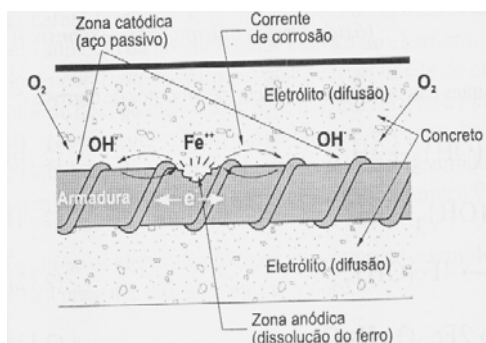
Processo corrosivo em armaduras do concreto.
